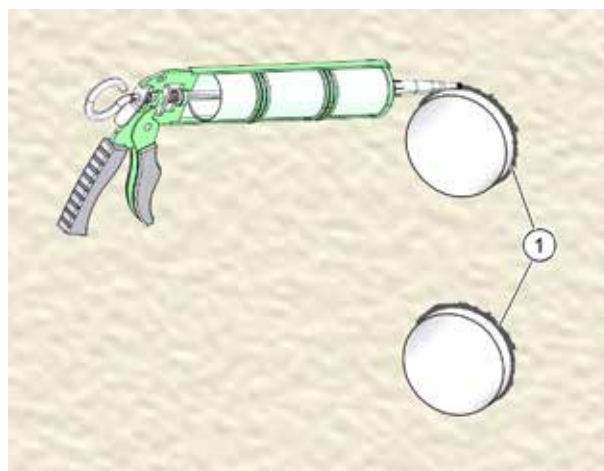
Impermeabilizzazione dei tubi dell'aria sulla parete esterna
